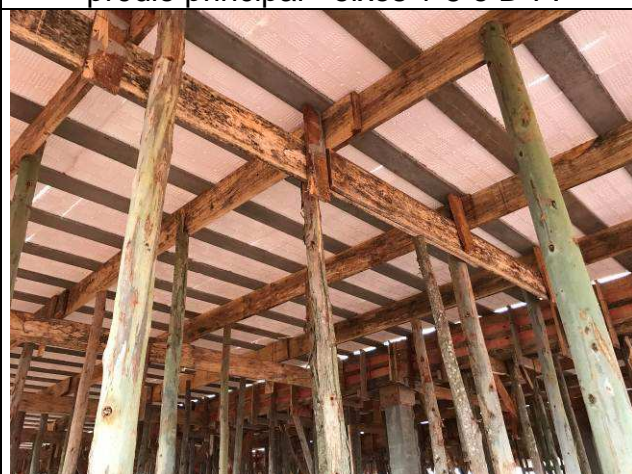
C: Laje e vigas de cobertura do prédio principal - eixos 1-5 e D-F.
